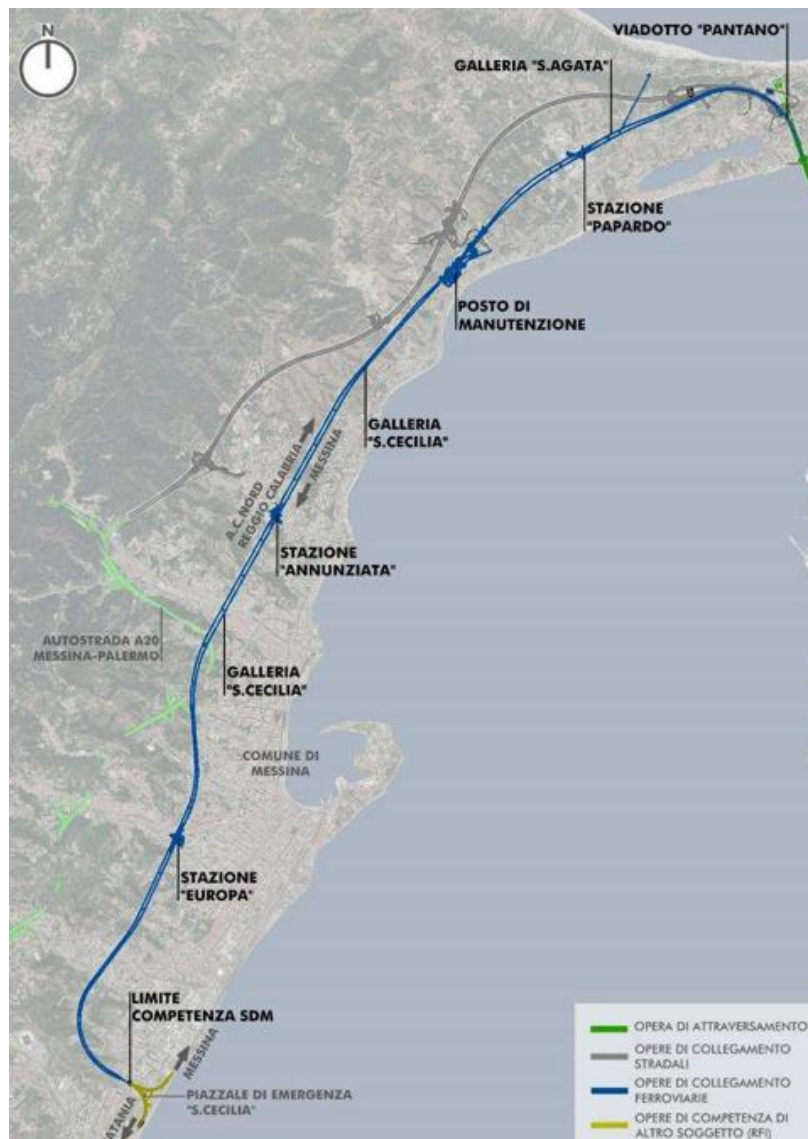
Stralcio planimetrico con indicazione dei principali elementi costituenti i collegamenti ferroviari di progetto sul versante Sicilia
